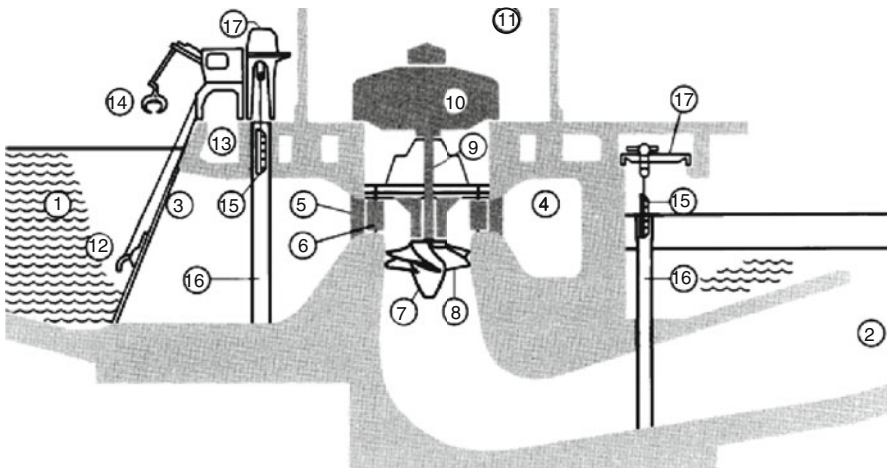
Laufwasserkraftwerk mit Kaplan-Turbine: 1 Oberwasser, 2 Unterwasser (Saug-rohr), 3 Rechen, 4 Einlaufspirale, 5 Stützschaufeln, 6 Laufschaufeln, 7 Lauftr, 8 Lauftr-schaufeln, 9 Turbinenwelle, 10 Generator, 11 Maschinenhaus, 12 Rechenreinigungsmaschine, 13 Geschwemm-selrinne, 14 Zangengreifer, 15 Dammbalken, 16 Nuten, 17 Krane [4.10]
